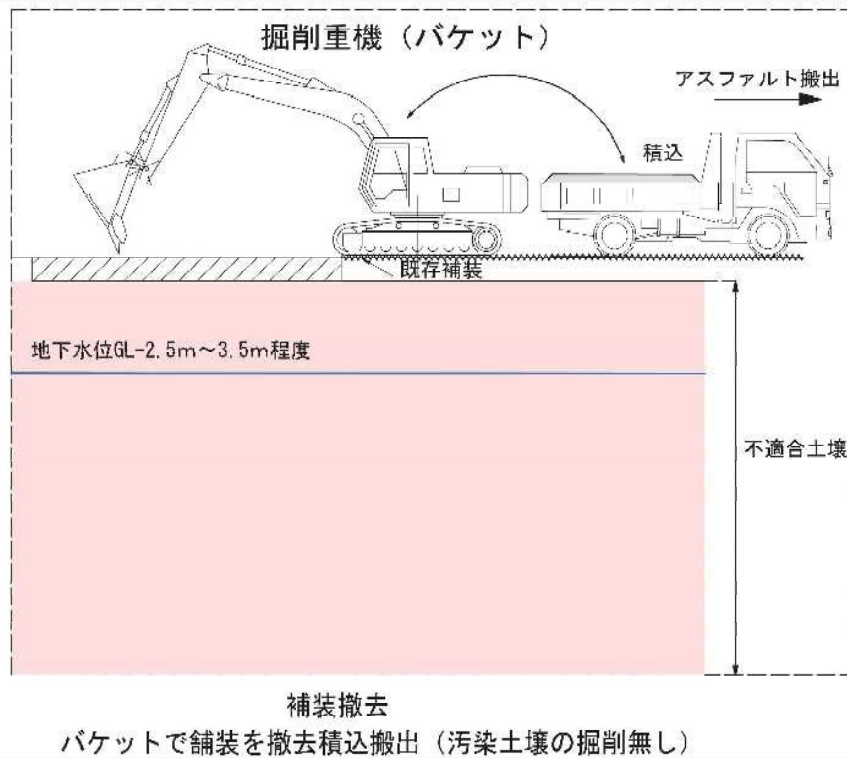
土地の形質の変更の施工方法を明らかにした断面図
